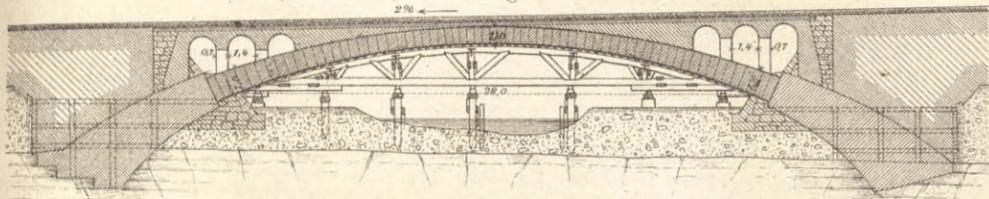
Murgbrücke unterhalb Baiersbronn.
